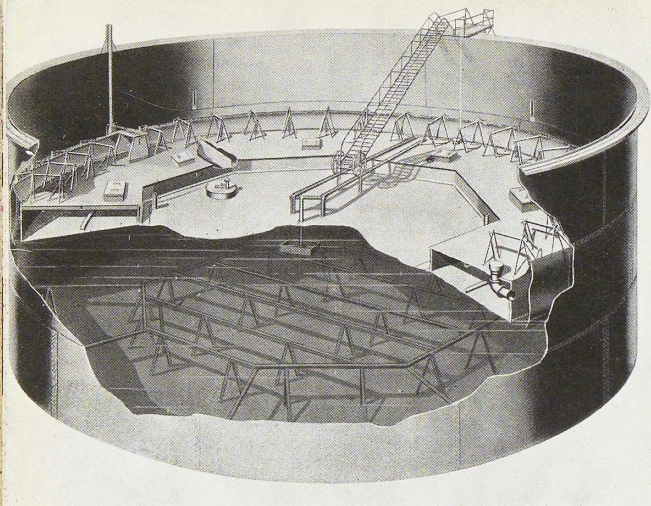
Section dans un tank à pétrole Wiggins à toit flottant construit par la firme Chicago Bridge and Iron Works.
